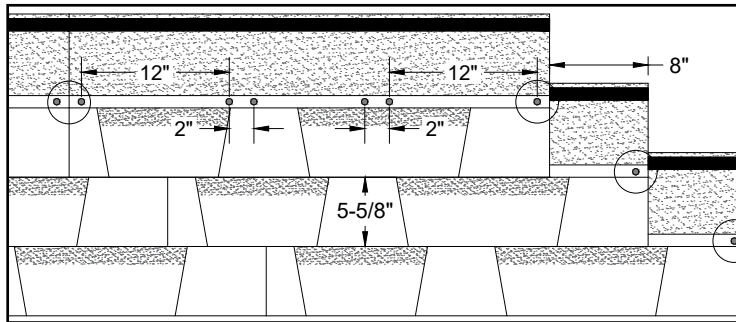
Plan de clouage alternatif 6 clous, bardeaux lamellés
